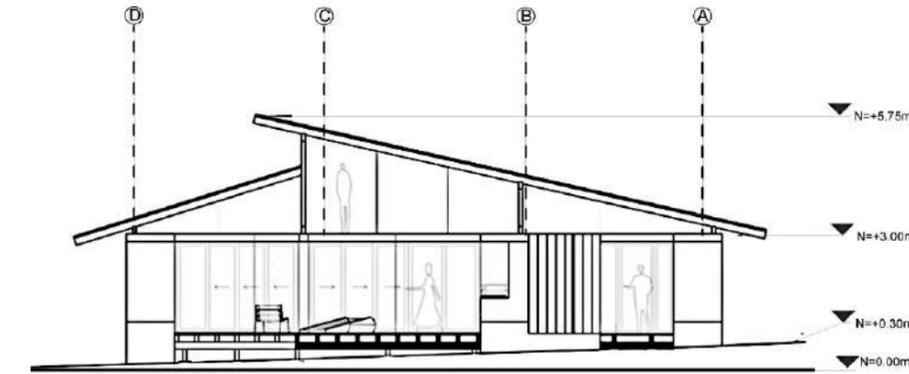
ELEVACIÓN POSTERIOR
